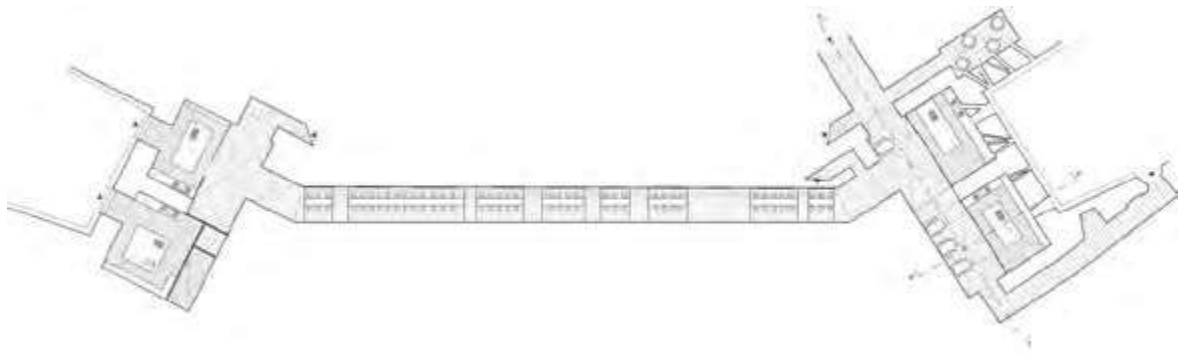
Planimetria di uno degli attraversamenti attrezzati interni alle mura.
